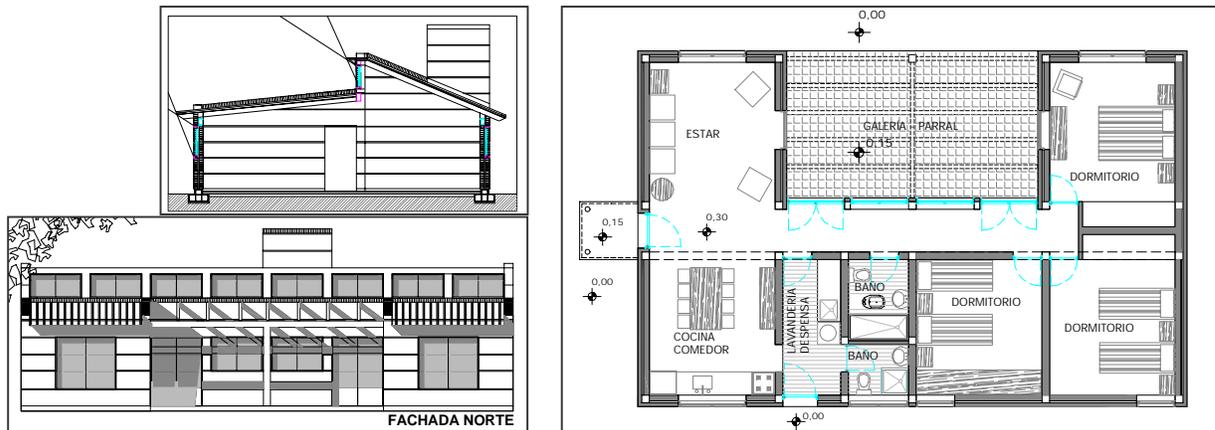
Vivienda analizada: Planta, corte y Fachada Norte.
